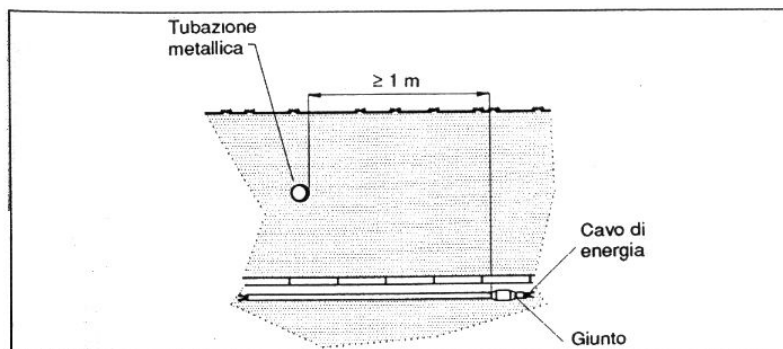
Le connessioni sui cavi devono distare in pianta almeno 1 m dal punto di incrocio con una tubazione metallica.
